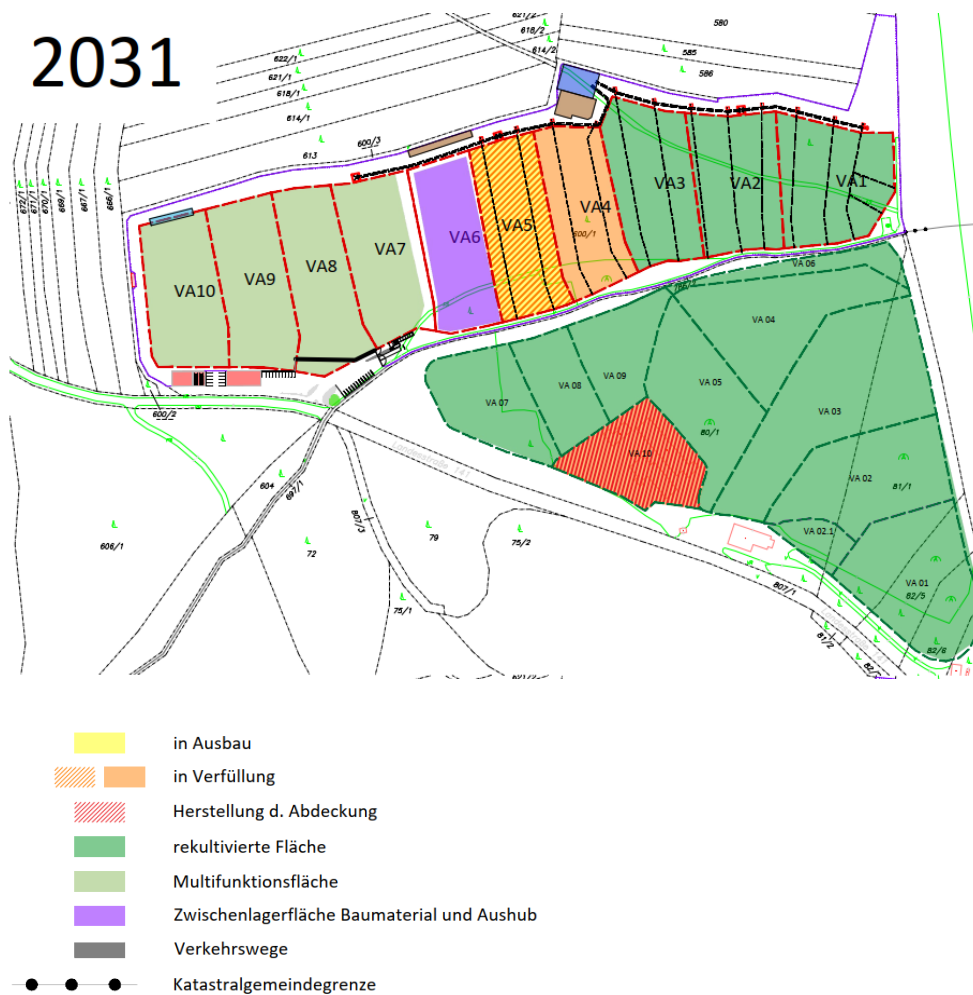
Betriebsphasenplan Deponie, Jahr 2031, dargestellt sind geplante und benachbarte bestehende Deponie (Quelle: Einreichoperat, Einlage 3054)
